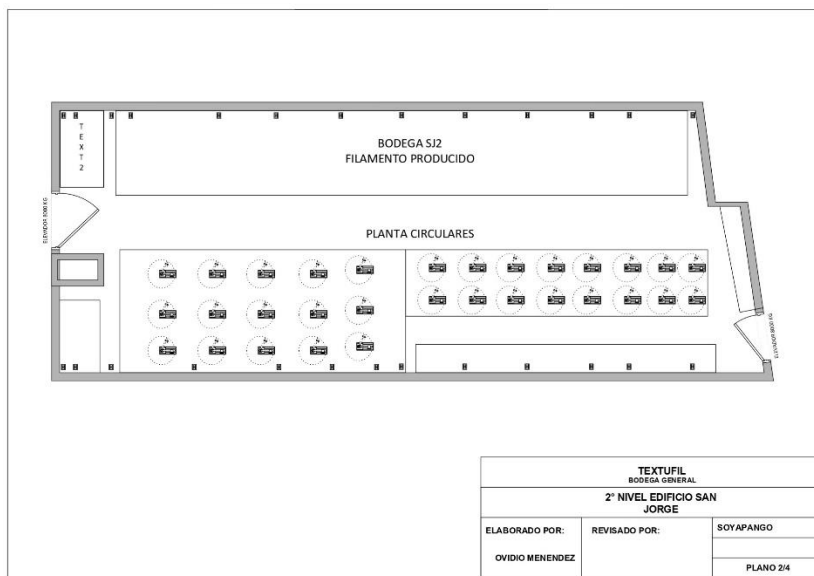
Distribución en Planta Nivel 2 edificio San Jorge
